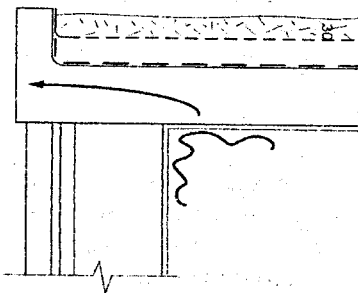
Схема теплоізоляції горишнього перекриття
